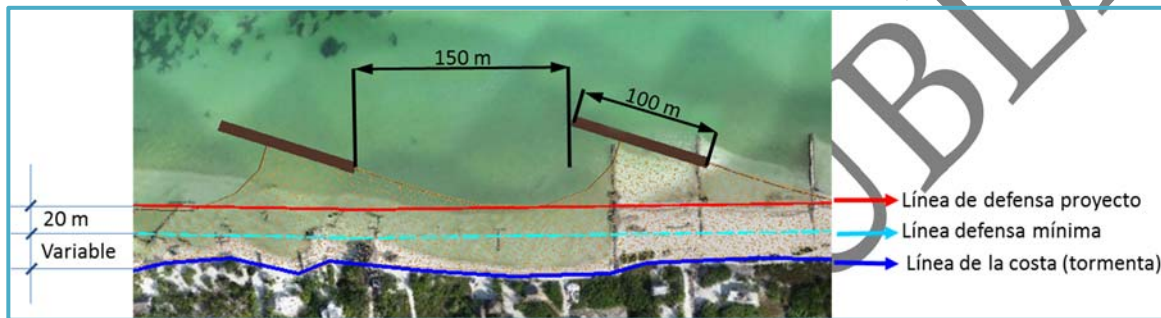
Arreglo en planta de una bahía de equilibrio.
